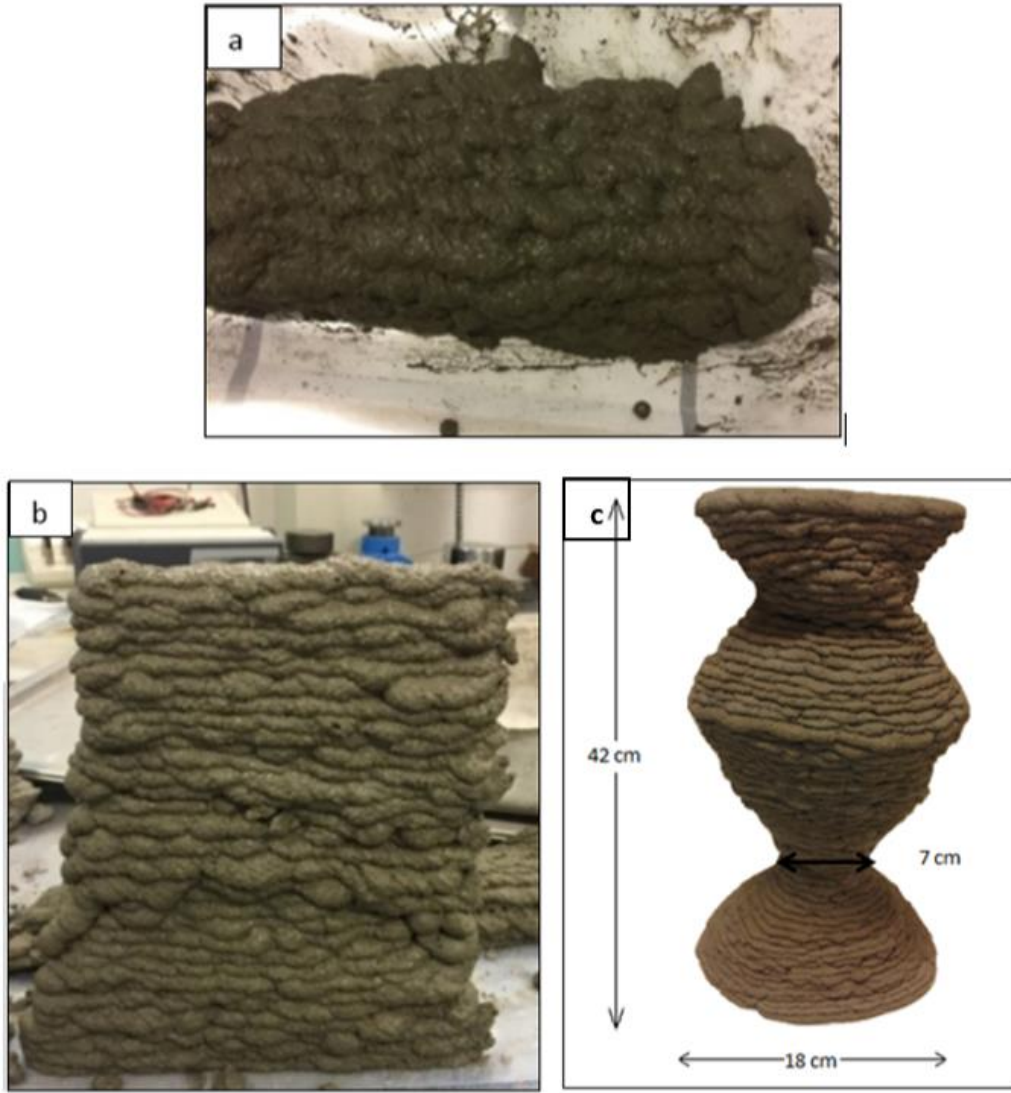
a) Effondrement d'un mortier constructible (environ 8 couches) en raison d'une instabilité de structure et b) construction « manuelle » d'une pièce de plus de trente couches avec l'encre rapide développée dans la thèse
